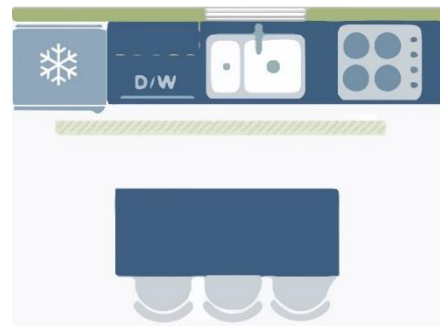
Layout com ilhéu sem aplicação do triângulo de trabalho.
